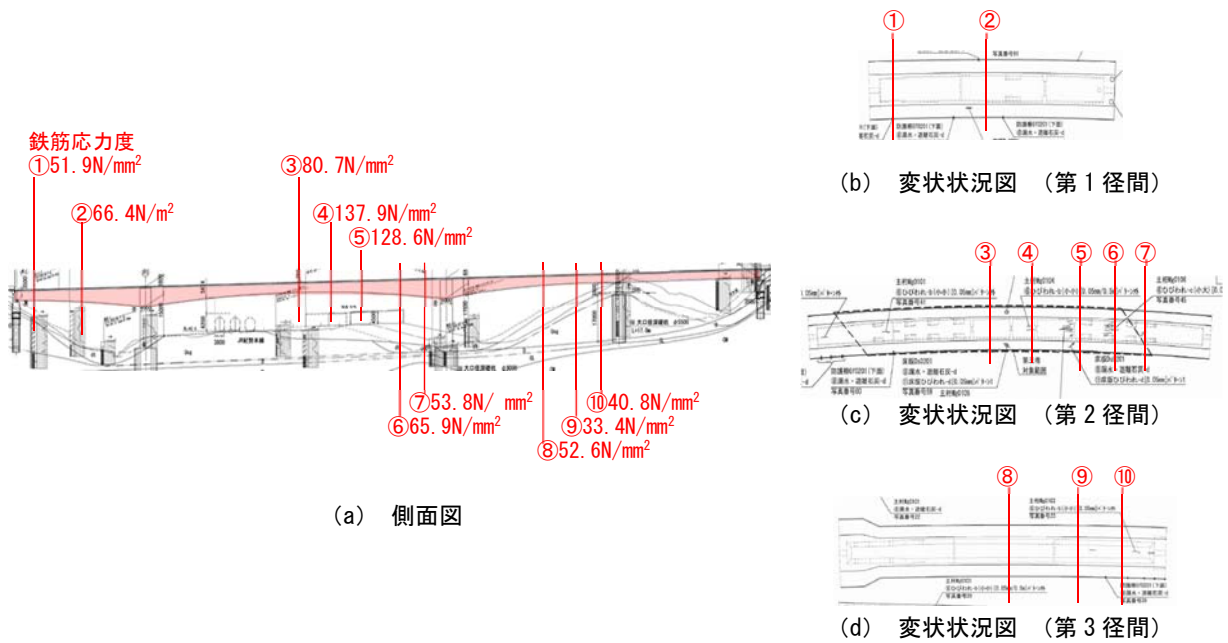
鉄筋応力度及び算出断面位置 (橋梁 No. 23)
